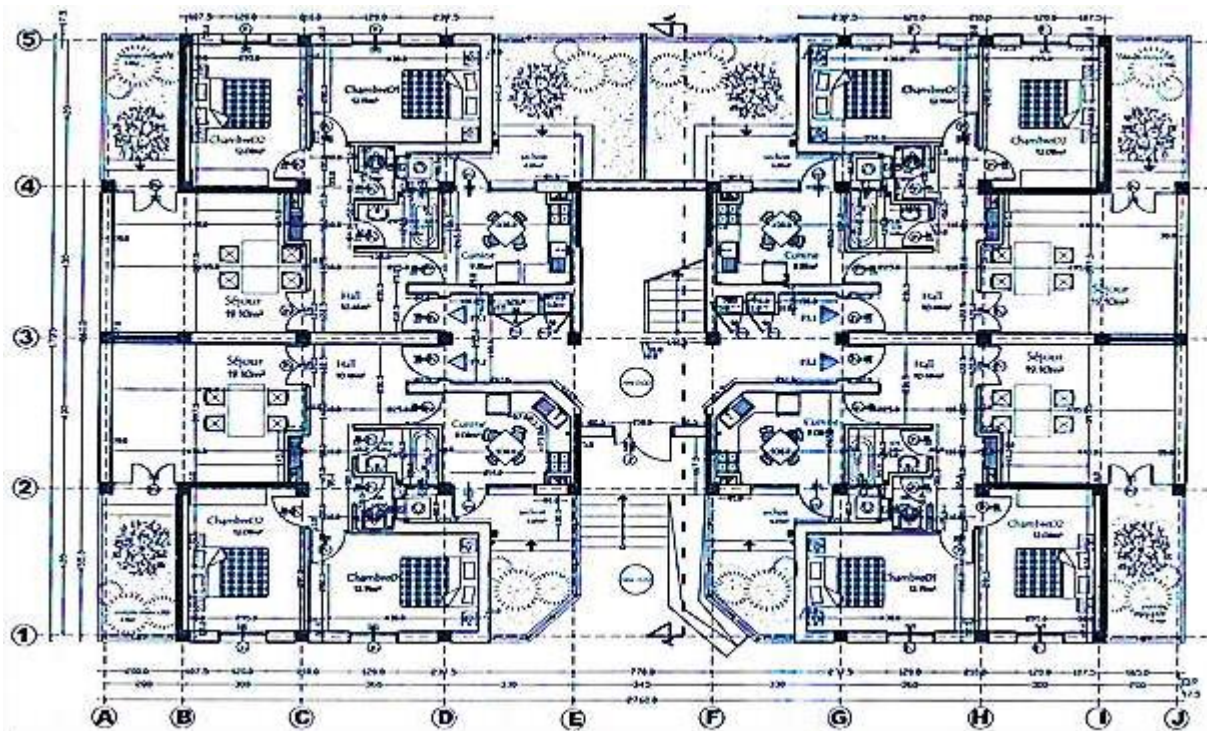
Plan du Rez-de-chaussée du bâtiment 02
